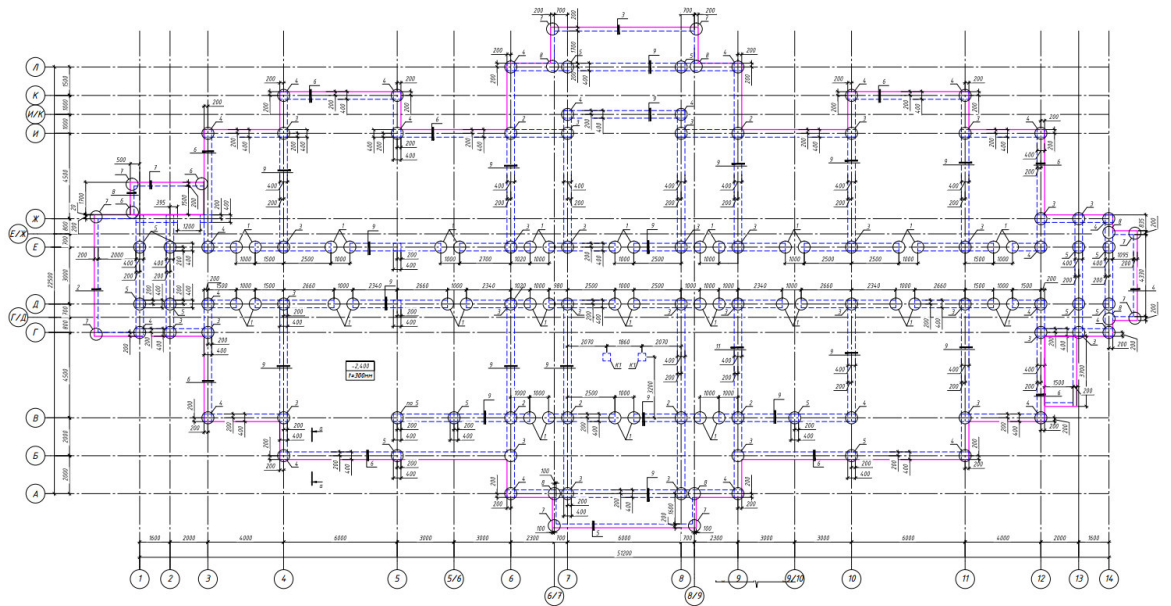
Схема устройства опалубочных конструкций под фундаментную плиту возводимого здания ДПЦ
